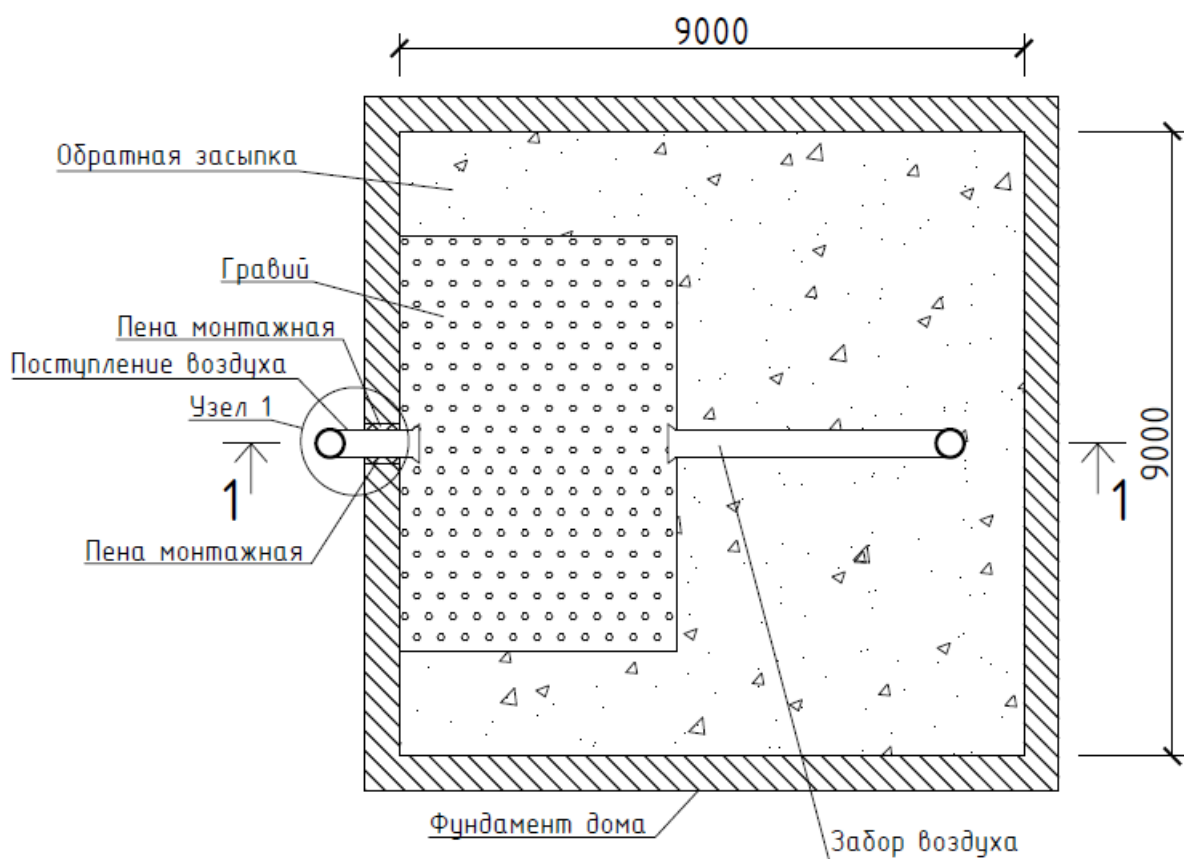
Вариант устройства бесканального теплообменника совместно с фундаментом здания
